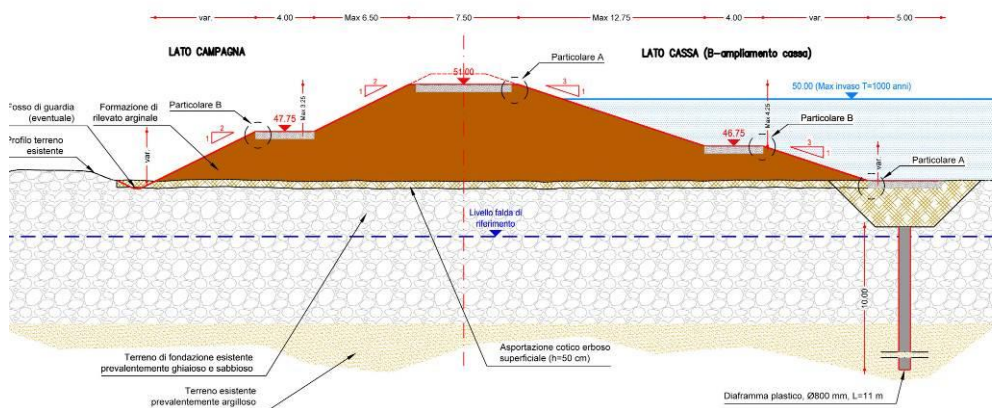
Intervento M: piantadell'ampliamento della cassa di espansione e sezioni tipo: la tipo "O" con diaframmi ex novo
